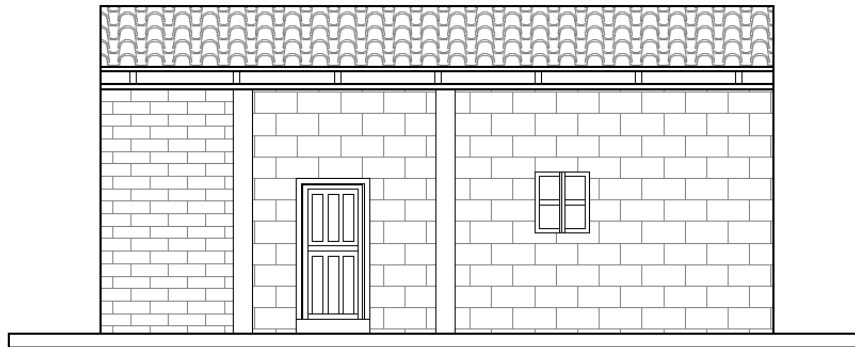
Vivienda de adobe reforzada con columnas de concreto armado. Dibujo Sebastián Araujo.
